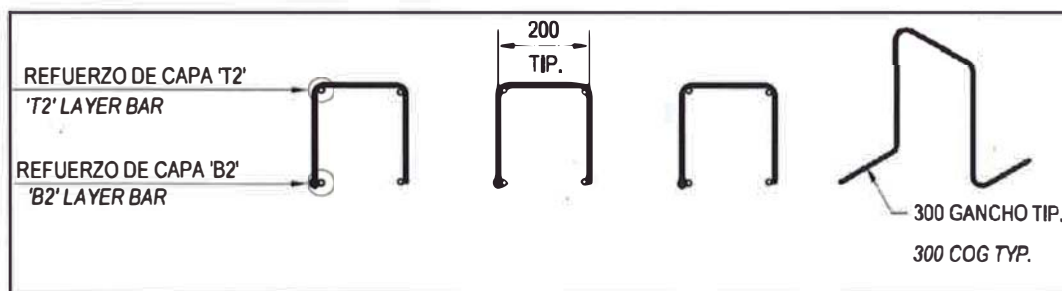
Sillas de corte para cimentaciones. Fuente: Planos del proyecto minero Constanca.
